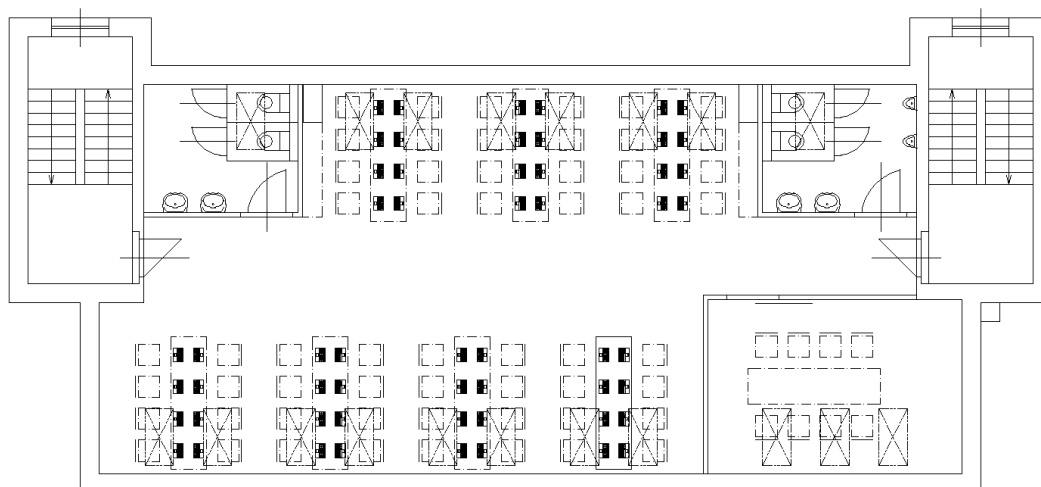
Slepý půdorys typického podlaží (1.NP – 3.NP)
